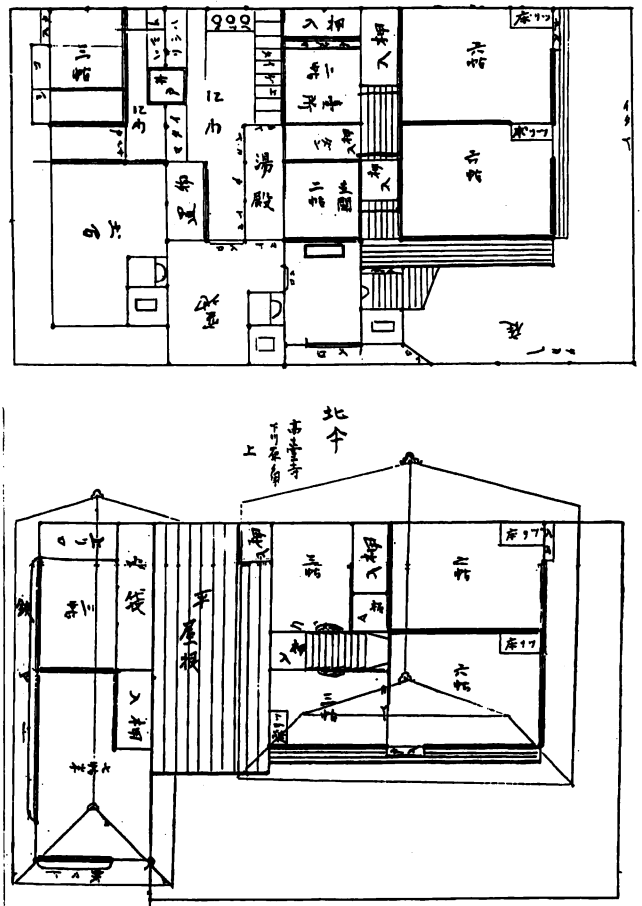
開発当初の家屋の平面図(1・2番)(上村家蔵)
